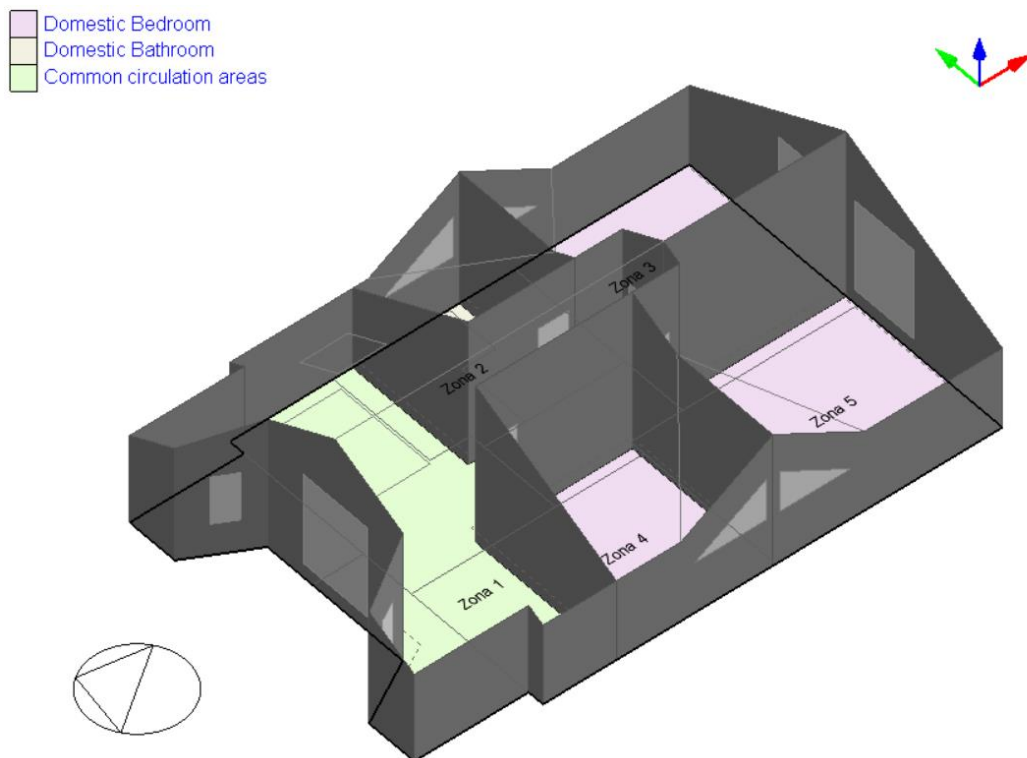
Modelado de la primera planta. (Fuente: DesignBuilder)
